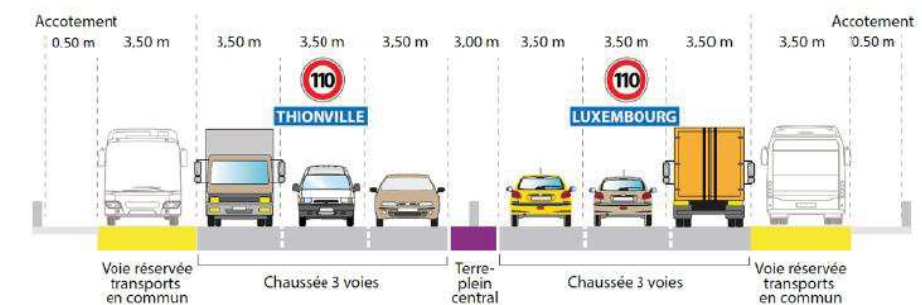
profil en travers de l'A31bis sur le secteur nord partie nord (source : dossier)
